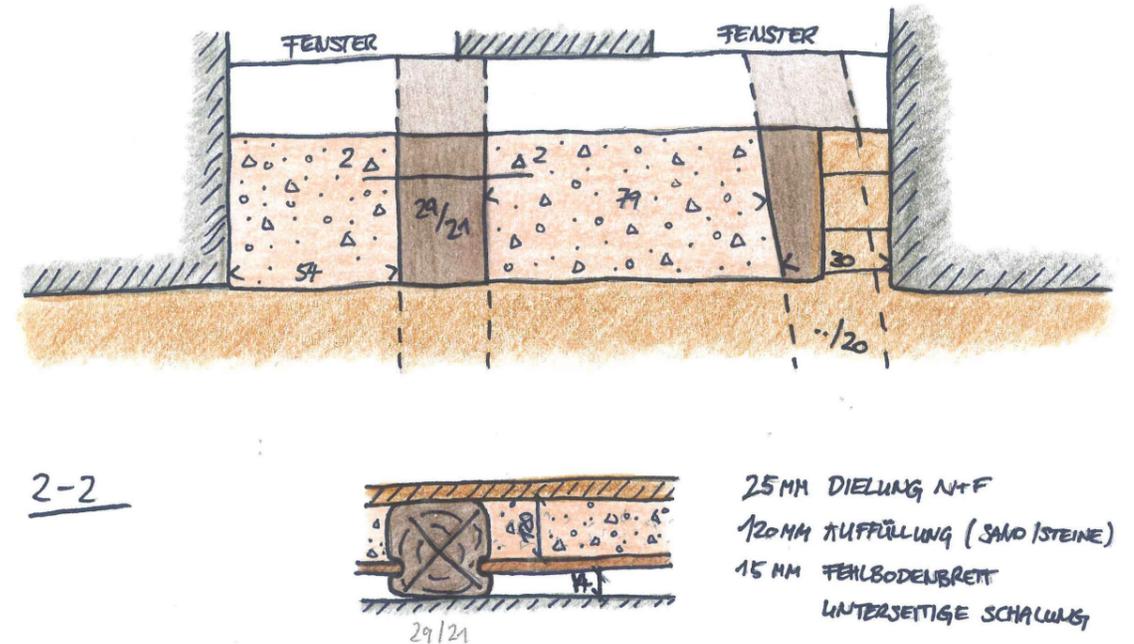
Bauteilöffnung der Deckenbalkenaufleger, Decke 1.OG - 2.OG
